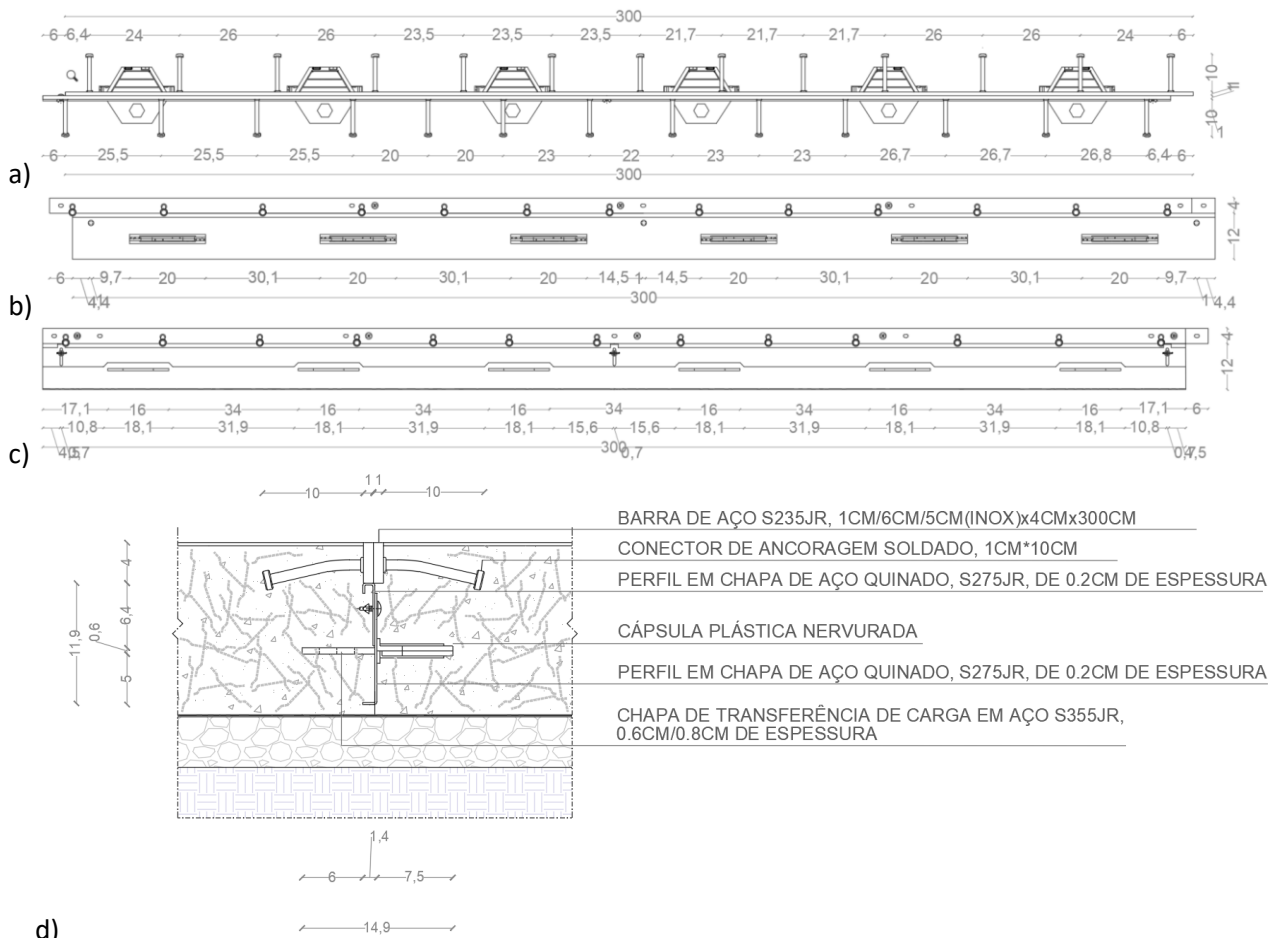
Desenhos de pormenor da StrongJoint Simple Wave: a) Vista superior; b) Vista lateral direita; c) Vista lateral esquerda; d) Corte transversal
